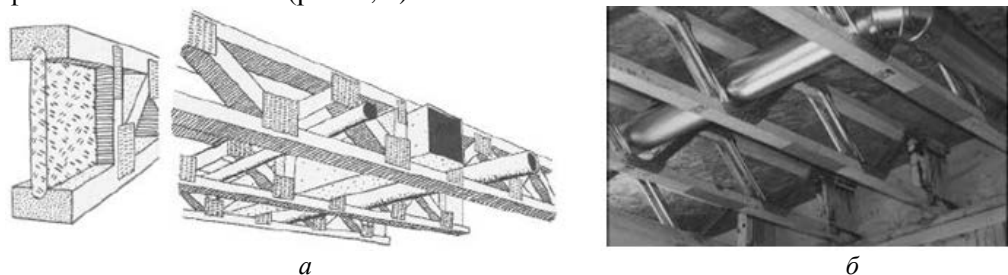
Конструкции ферм с использованием двутавров из древесного пластика: *а* – соединение конструкции металлическими пластинами (вид с разных сторон); *б* – комбинированное соединение
